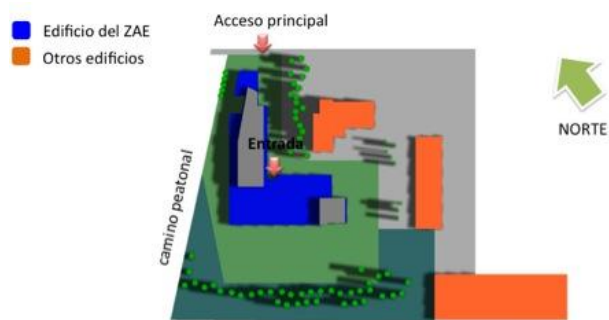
Planta de conjunto del proyecto propuesto para el ZAE. Fuente: Elaboración Propia
